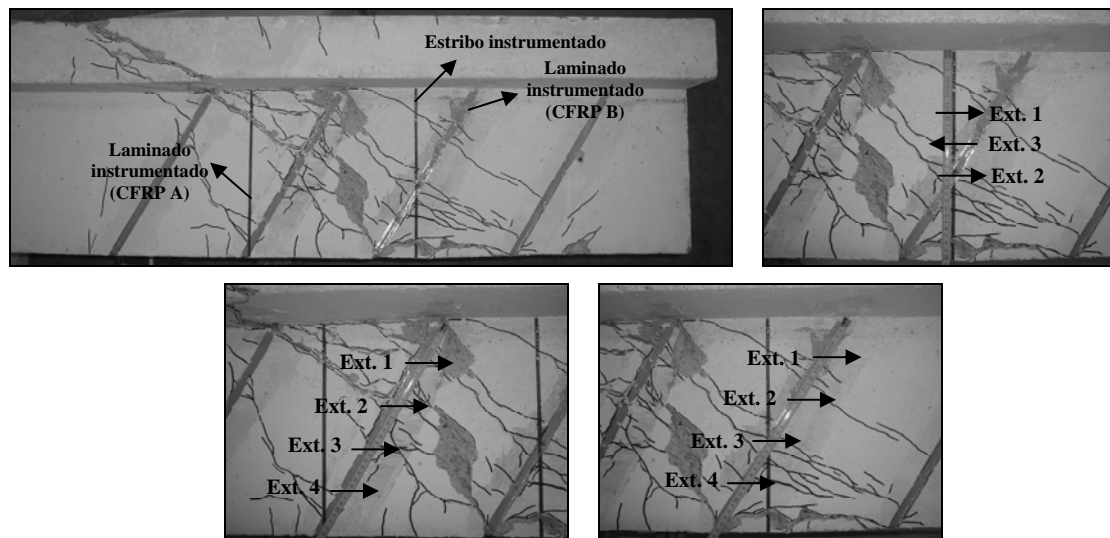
Localização dos extensómetros no laminado e estribo instrumentados da viga 2S-4LI60-C.
